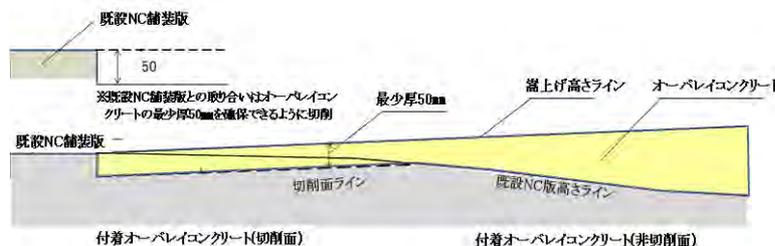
接着剤併用型薄層付着オーバーレイ工法における施工断面図
